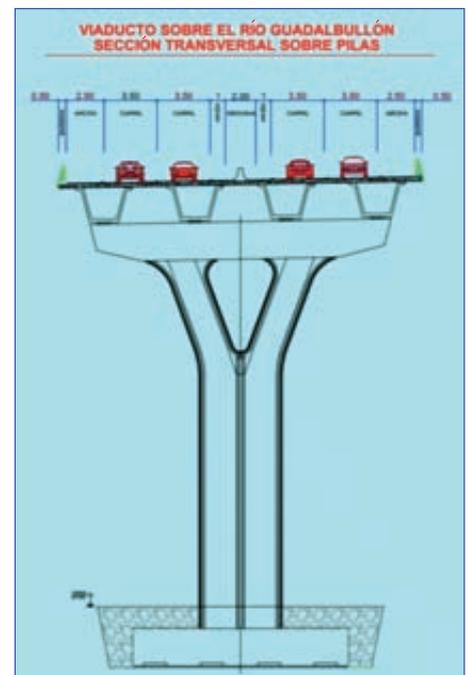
Detalle de la pila en forma de Y del viaducto de Guadalbullón.
